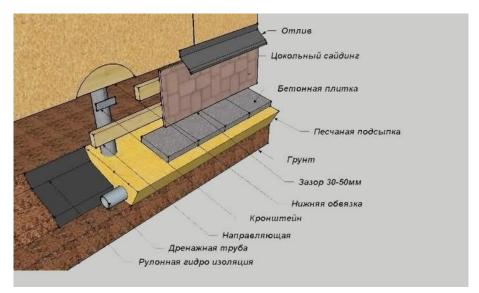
Схема устройства утепленного фундамента в зимний период
